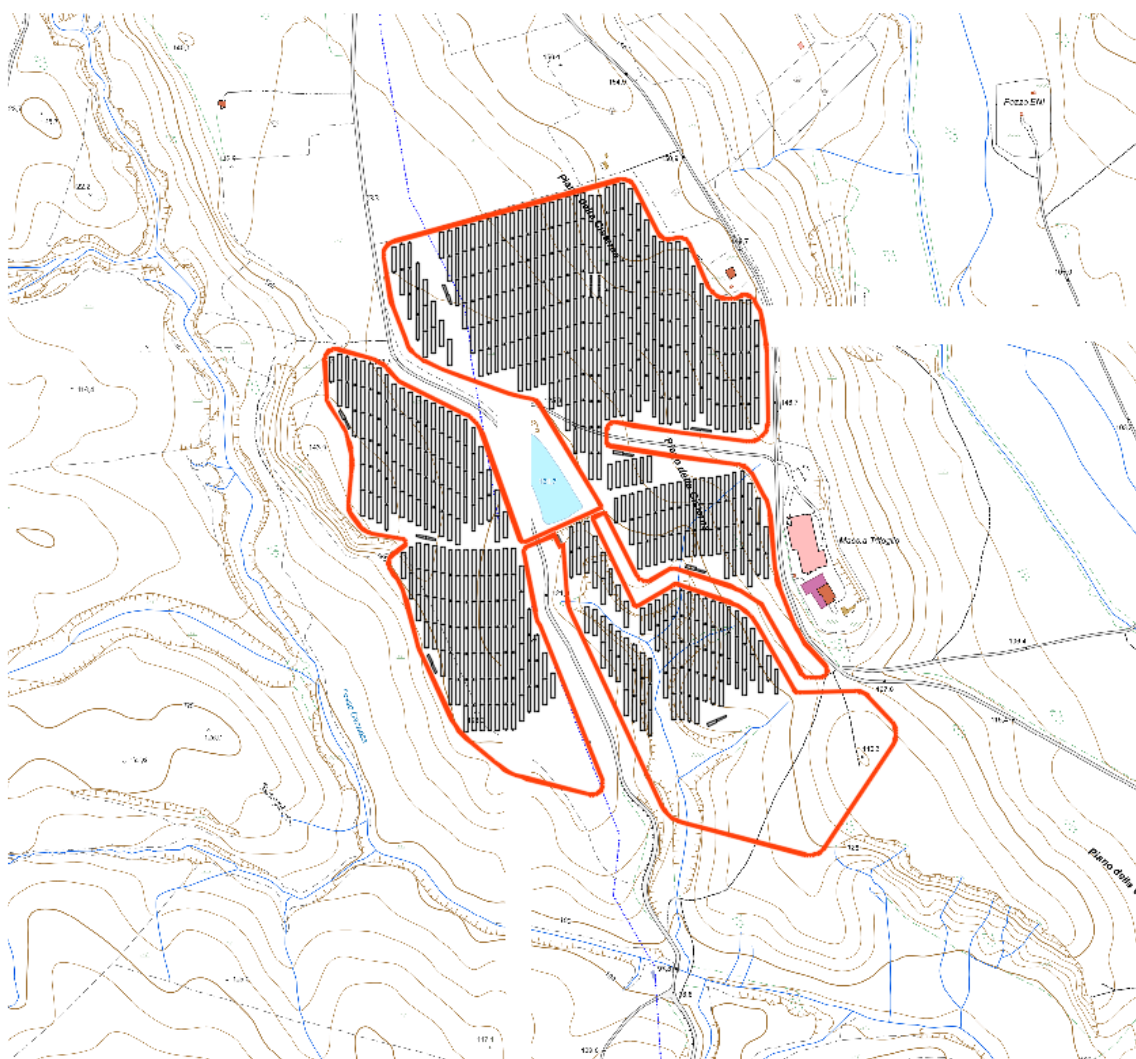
Stralcio della C.T.R. con individuazione dell'impianto
